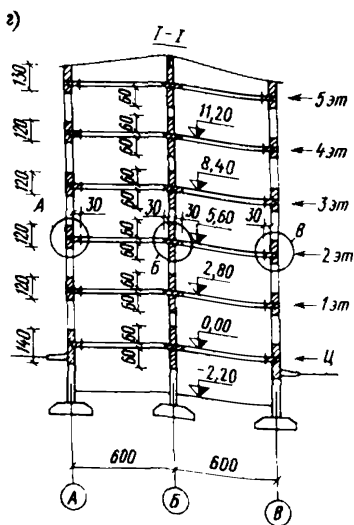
Расчетная схема крупнопанельного жилого дома II типа с продольными несущими стенами
